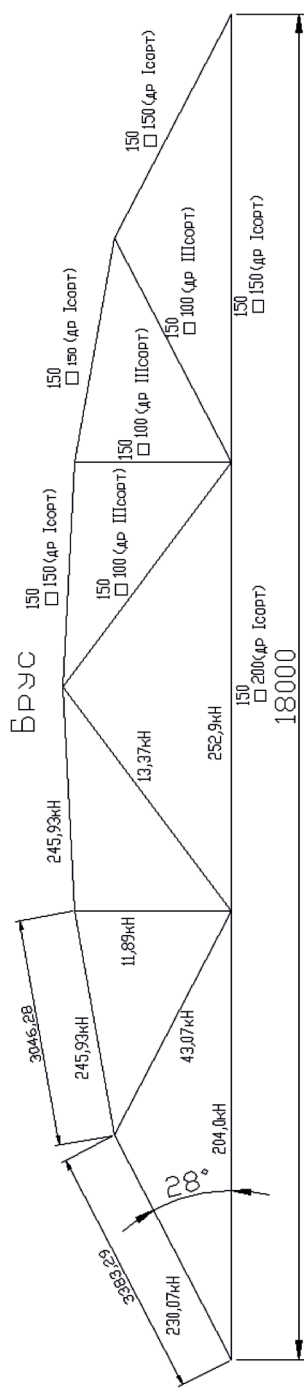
Конструкция деревянной фермы пролетом 18 м из древесины (пиломатериал)
